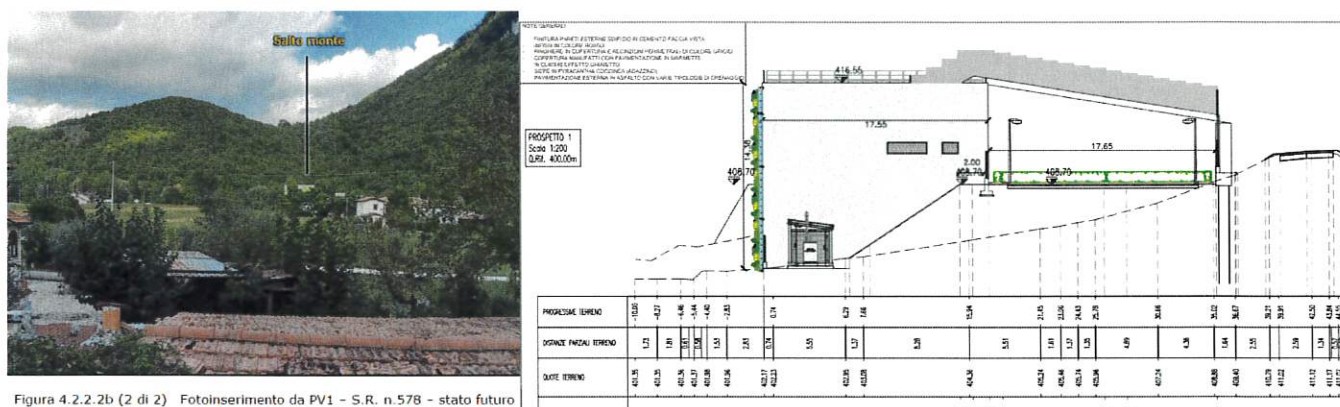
(2 di 2) Fotoinserimento da PV1 - S.R. n.578 - stato futuro
